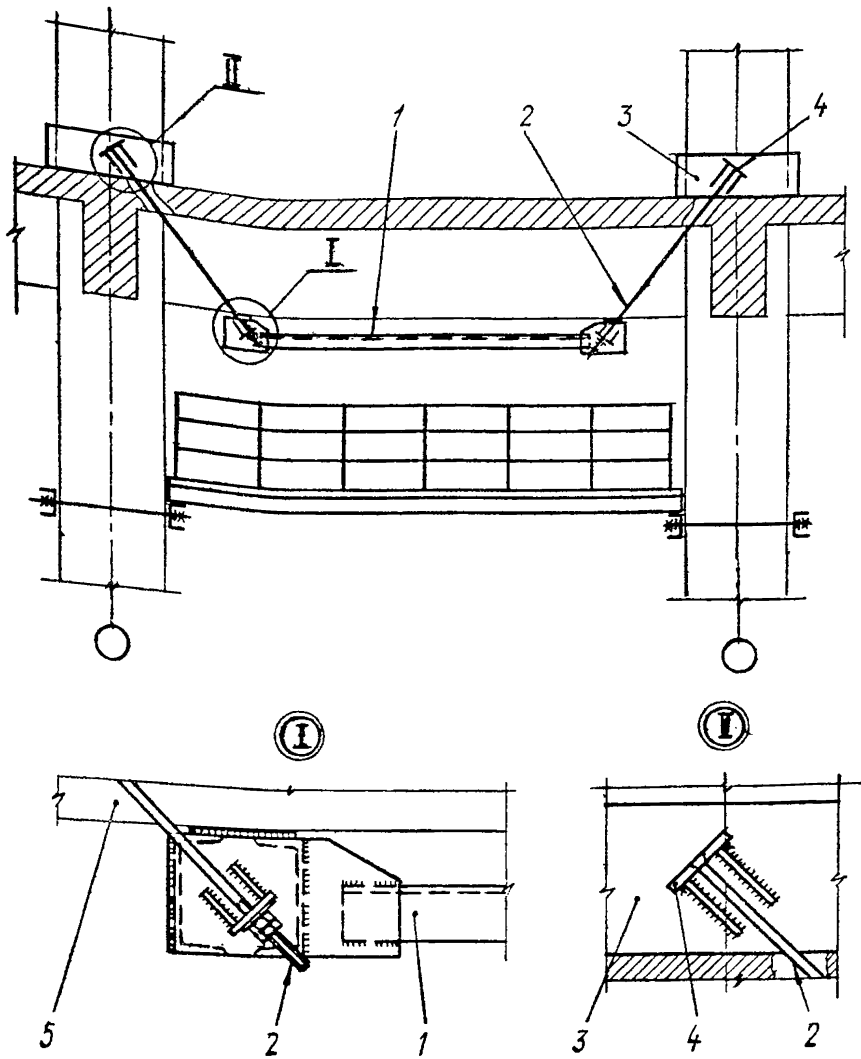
Рис. I.II. Схема усиления балки шпренгельной затяжкой с креплением на упорах обойм колонн:
